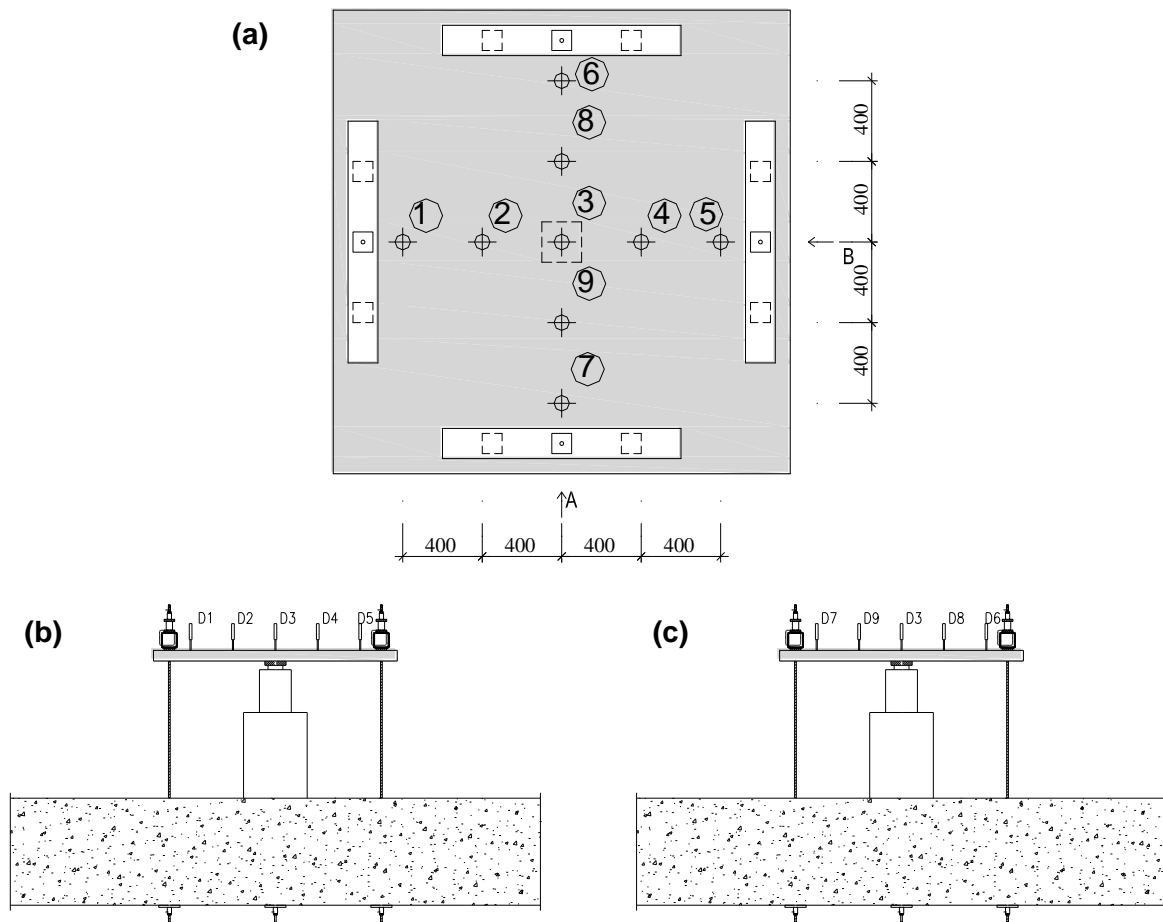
Localização dos deflectómetros, (a) em planta, (b) vista por A e (c) vista por B DF7 (desenho sem escala e dimensões em mm).
